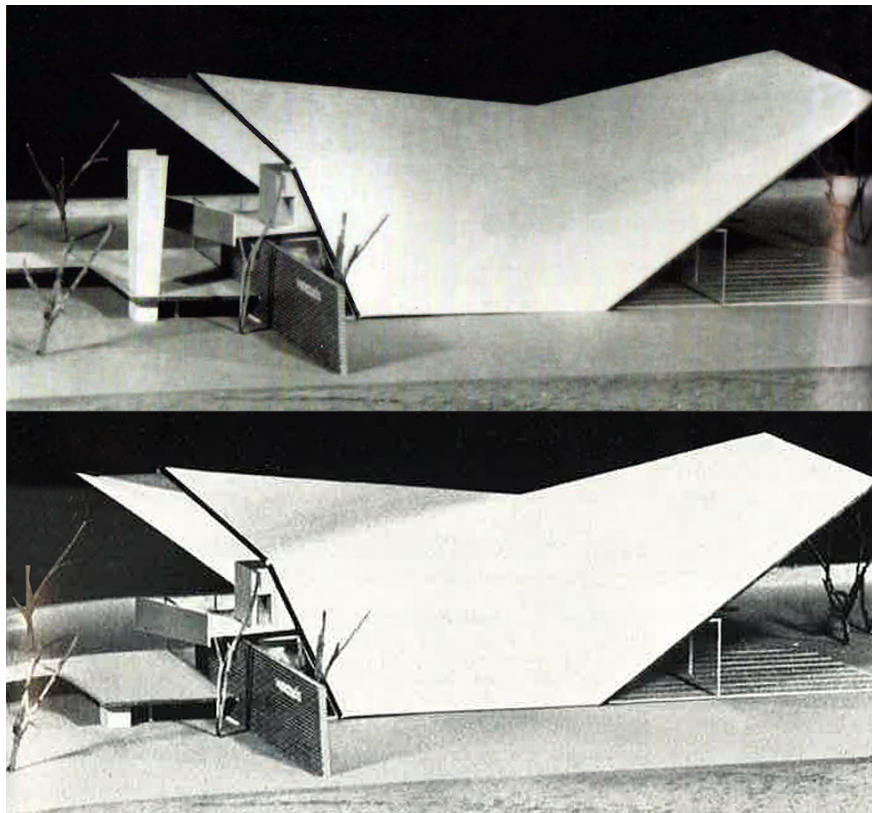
Maqueta original con y sin hito (fuente: Bermúdez 1957 y Revista Bauwelt 1957a).
